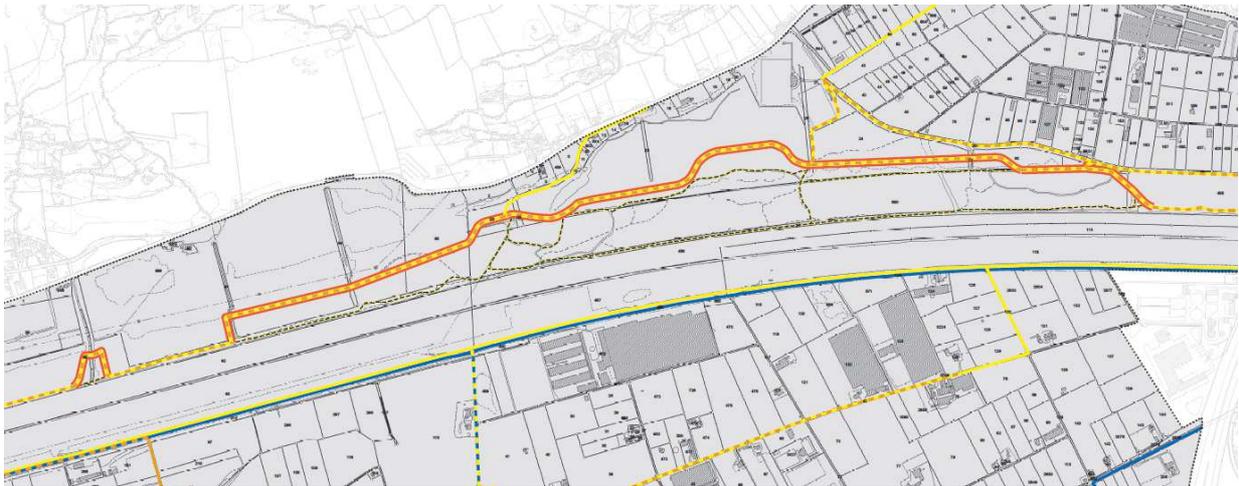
Estratto Piano delle dell'urbanizzazione a variante
